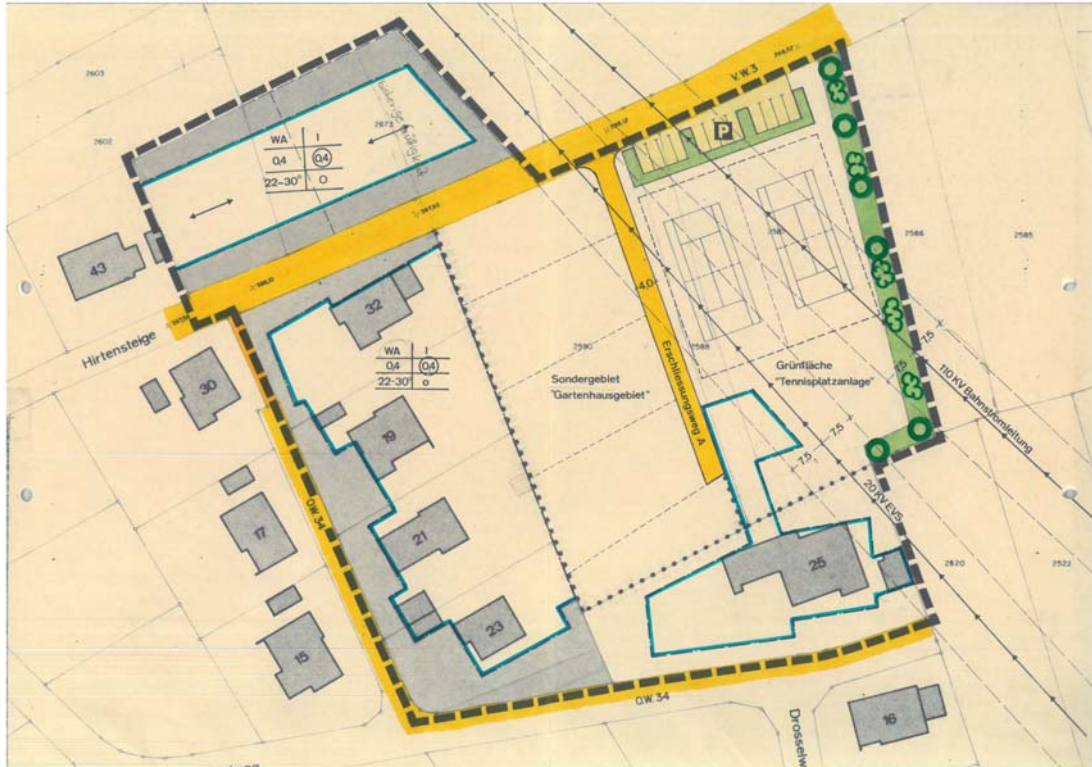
Bebauungsplan „Ellwanger Baum“ 2. Änderung und 2. Erweiterung
